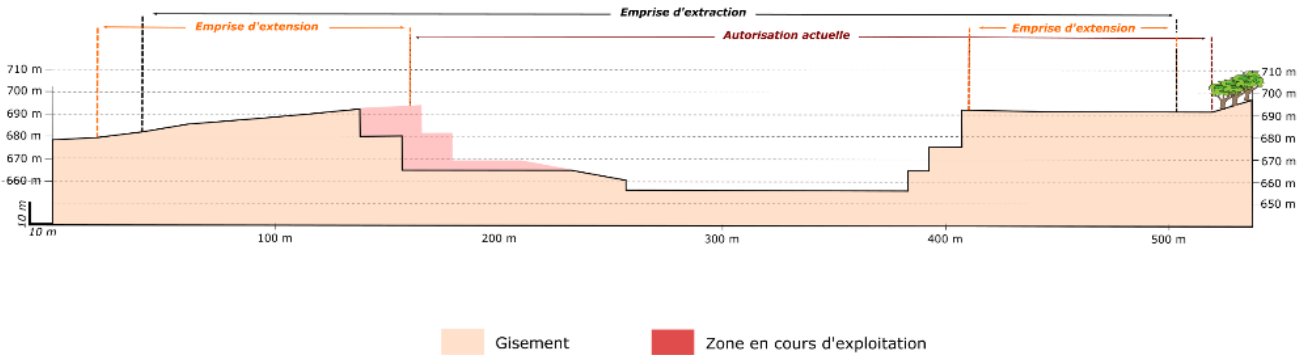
Plan et coupes schématiques de l'état actuel du site
